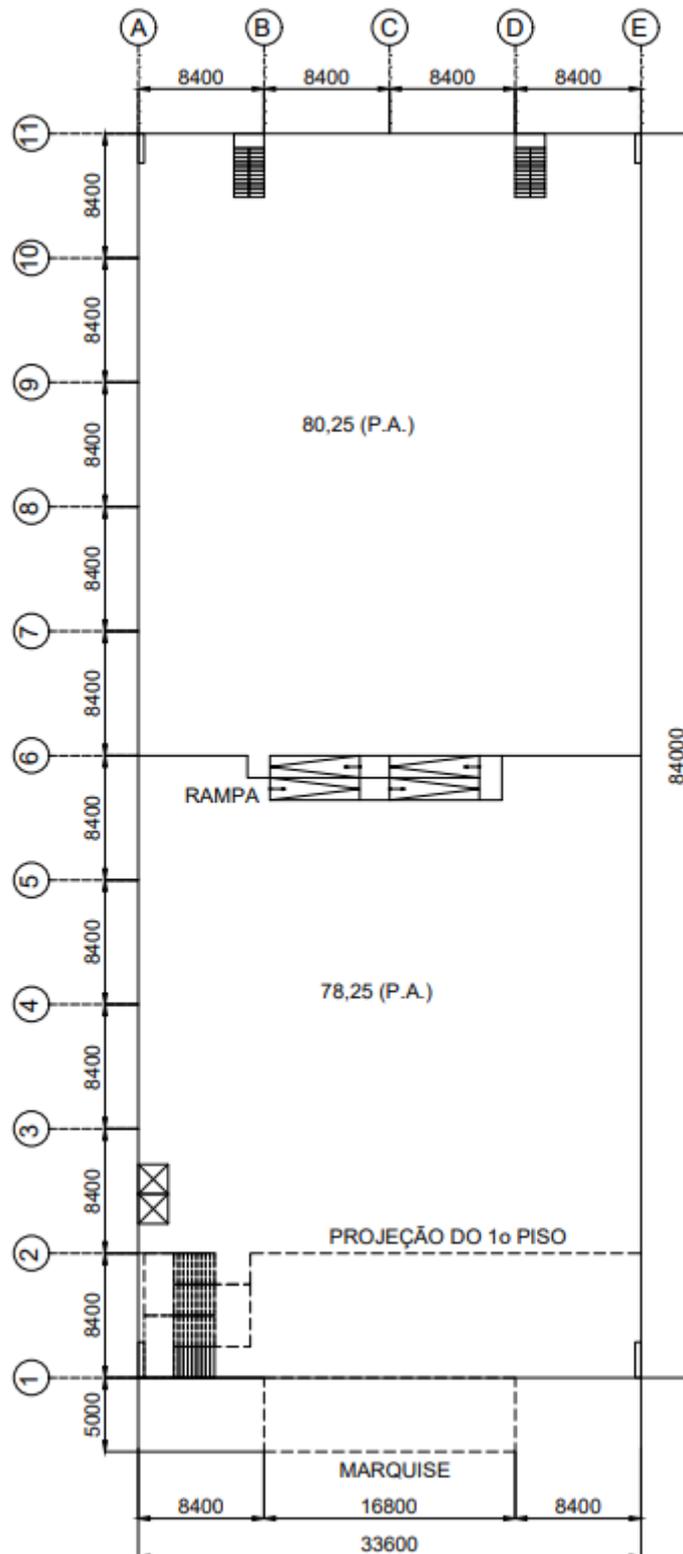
Planta do térreo (cotas de nível em metros e medidas em mm; P.A. = piso acabado)
